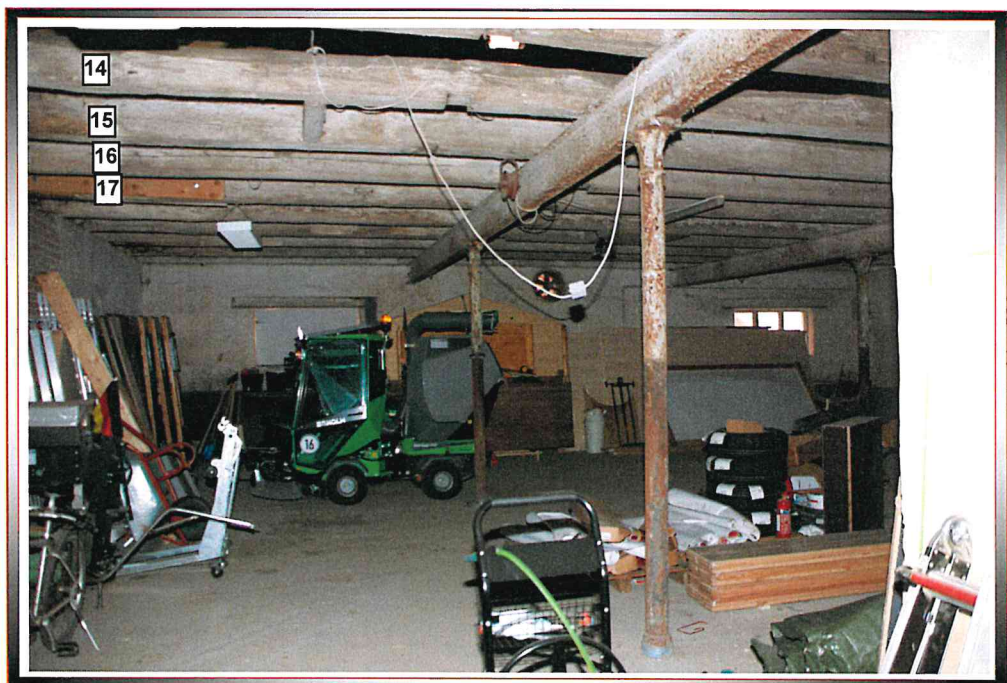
Deckenbalkenlage über der Werkhalle mit Stahlunterzug und Gussstützen
